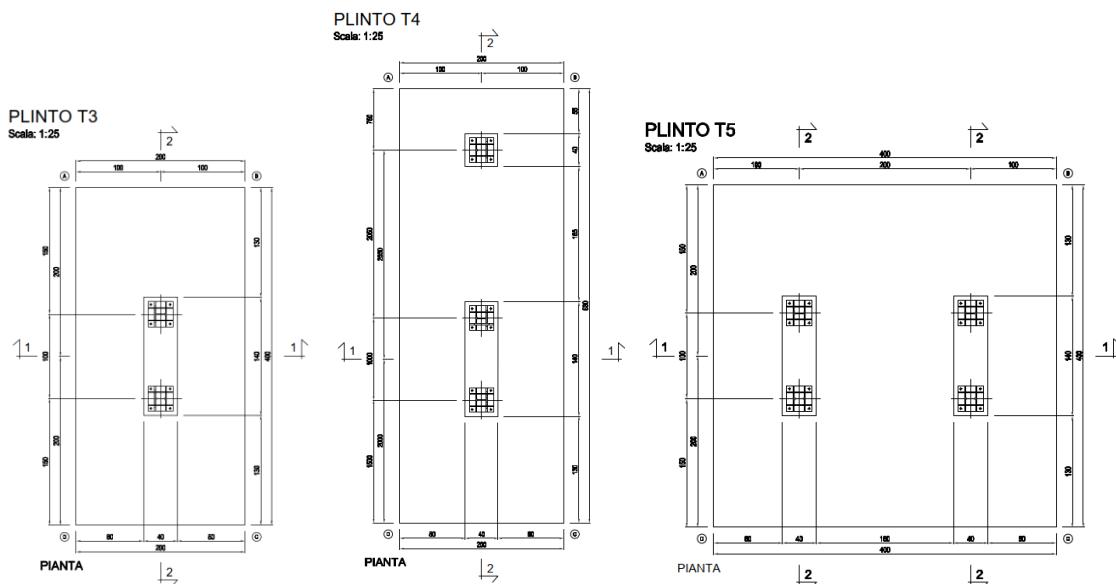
Geometria della fondazione – PLINTI T3, T4 e T5
